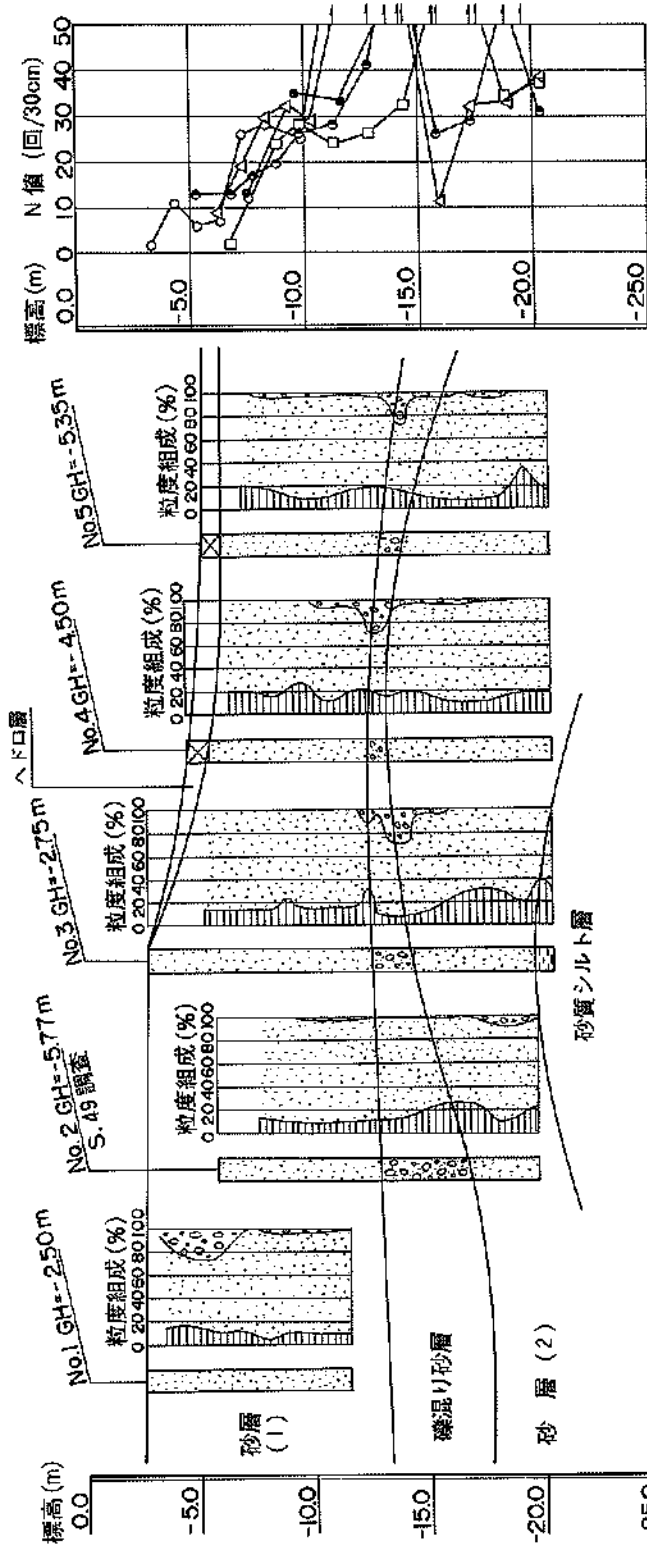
縦断面図 (第2埠頭地区, ⑦西側岸壁(-7.5m))
